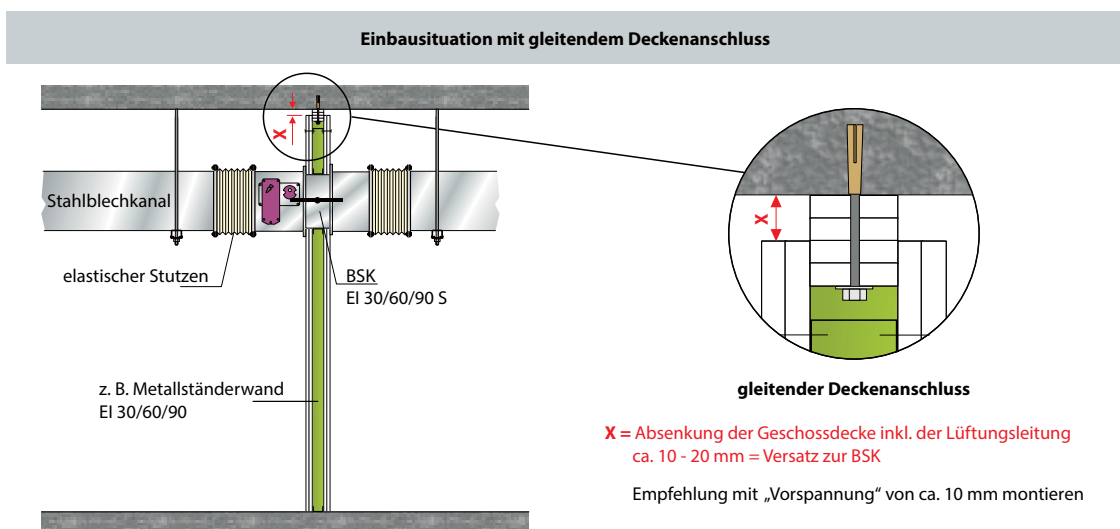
Einbausituation gleitender Deckenanschluss bei Metallständerwänden / Trockenbauwänden
